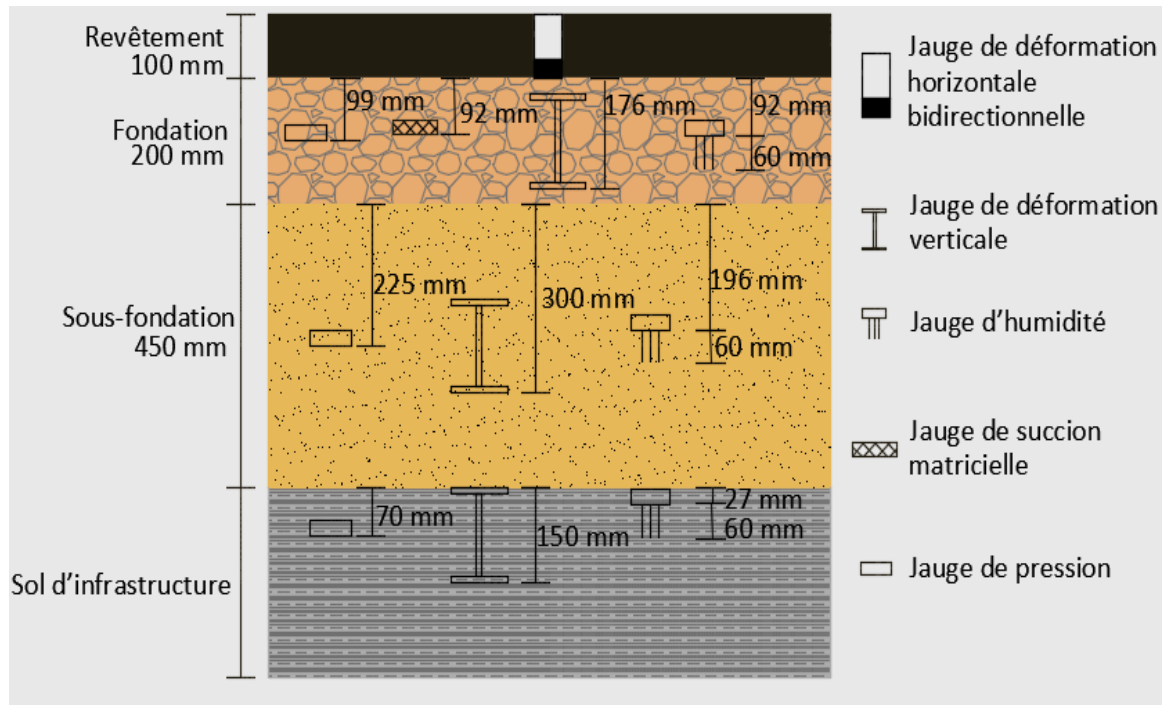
Stratigraphie et l'instrumentation installée dans la fosse d'essai
